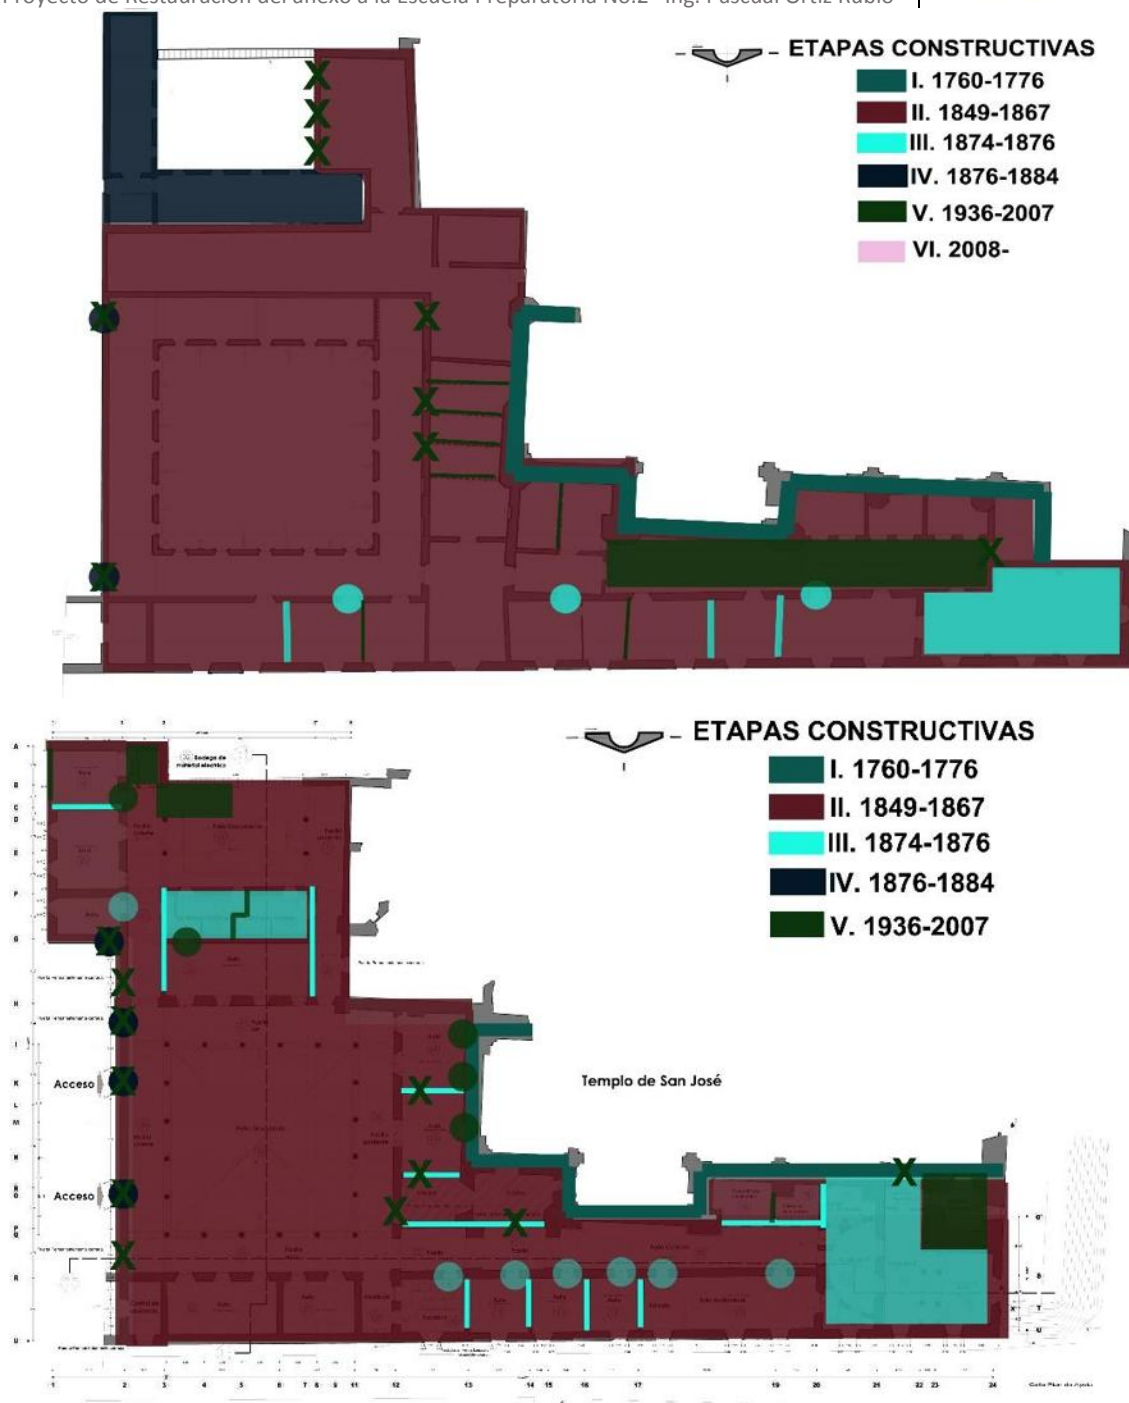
Quinta etapa (Planta baja)¹²⁹
